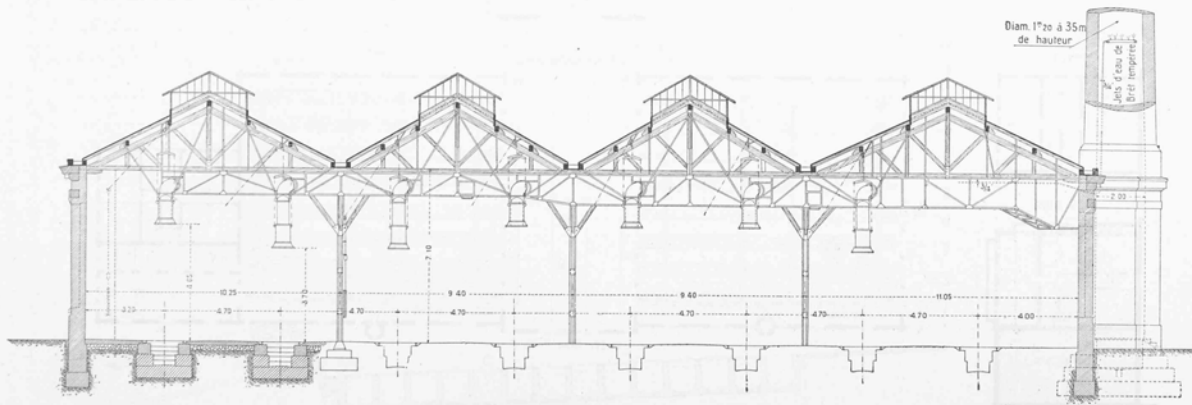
Coupe transversale C-D. — 1 : 200.
